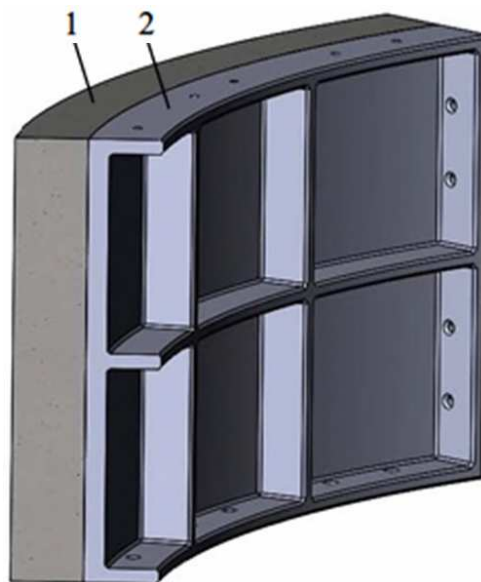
Схема комбинированной двухслойной крепи из монолитного бетона и чугунной колонны: 1 – бетон; 2 – чугунные тубинги
